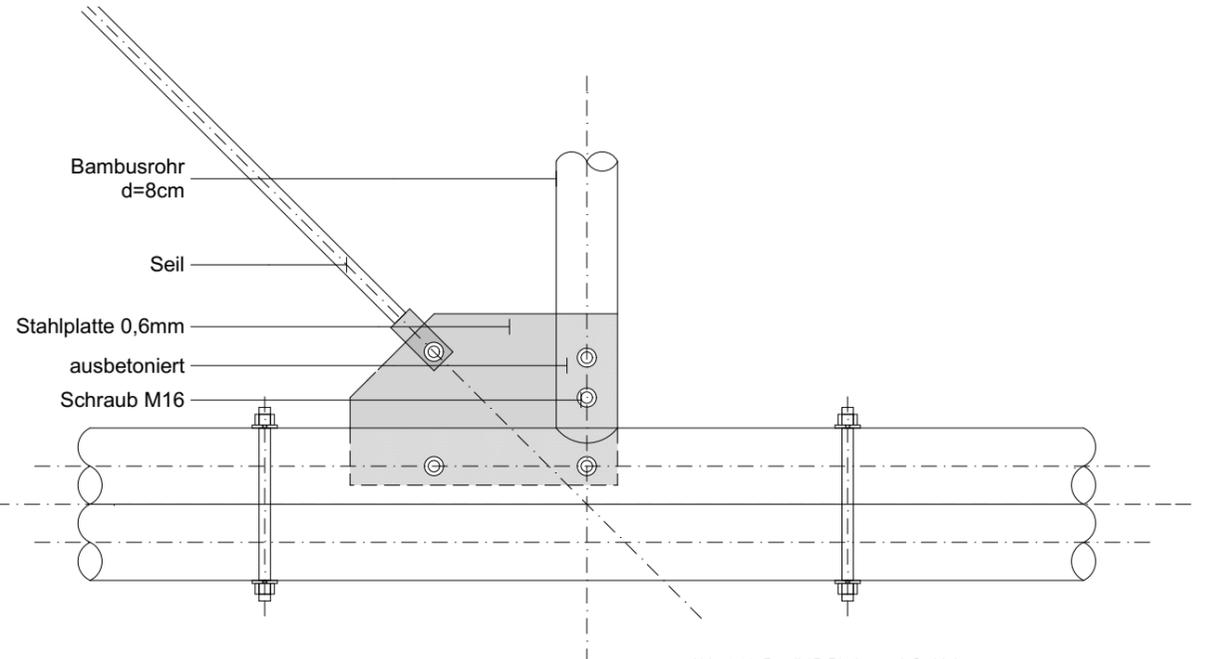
Detail 2D Bindung mit Stahlplatte
